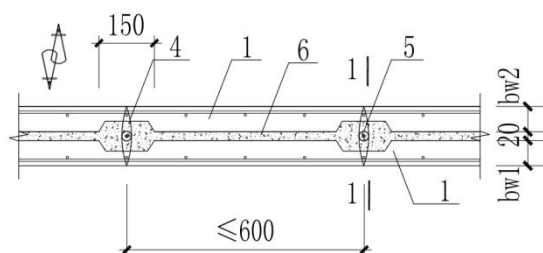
墙体预埋钢丝绳拉环灌浆连接构造示意图
